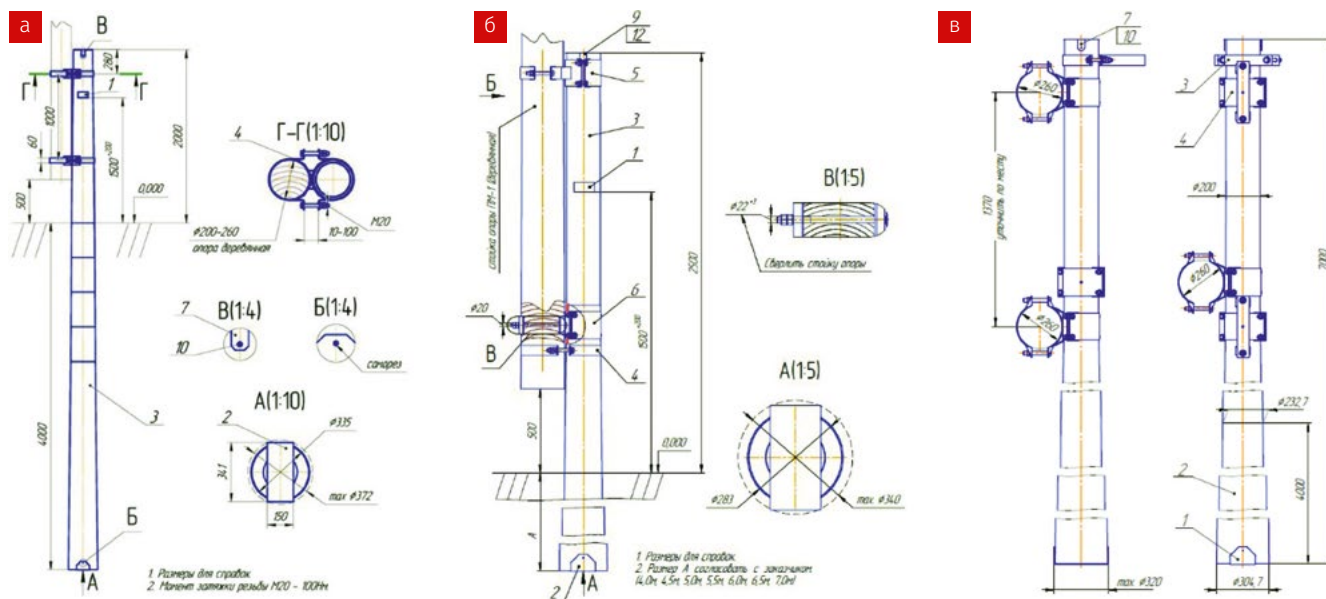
ФР промежуточных опор: а. свая П-60-003; б. свая П-60-006; в. свая П-70-005
